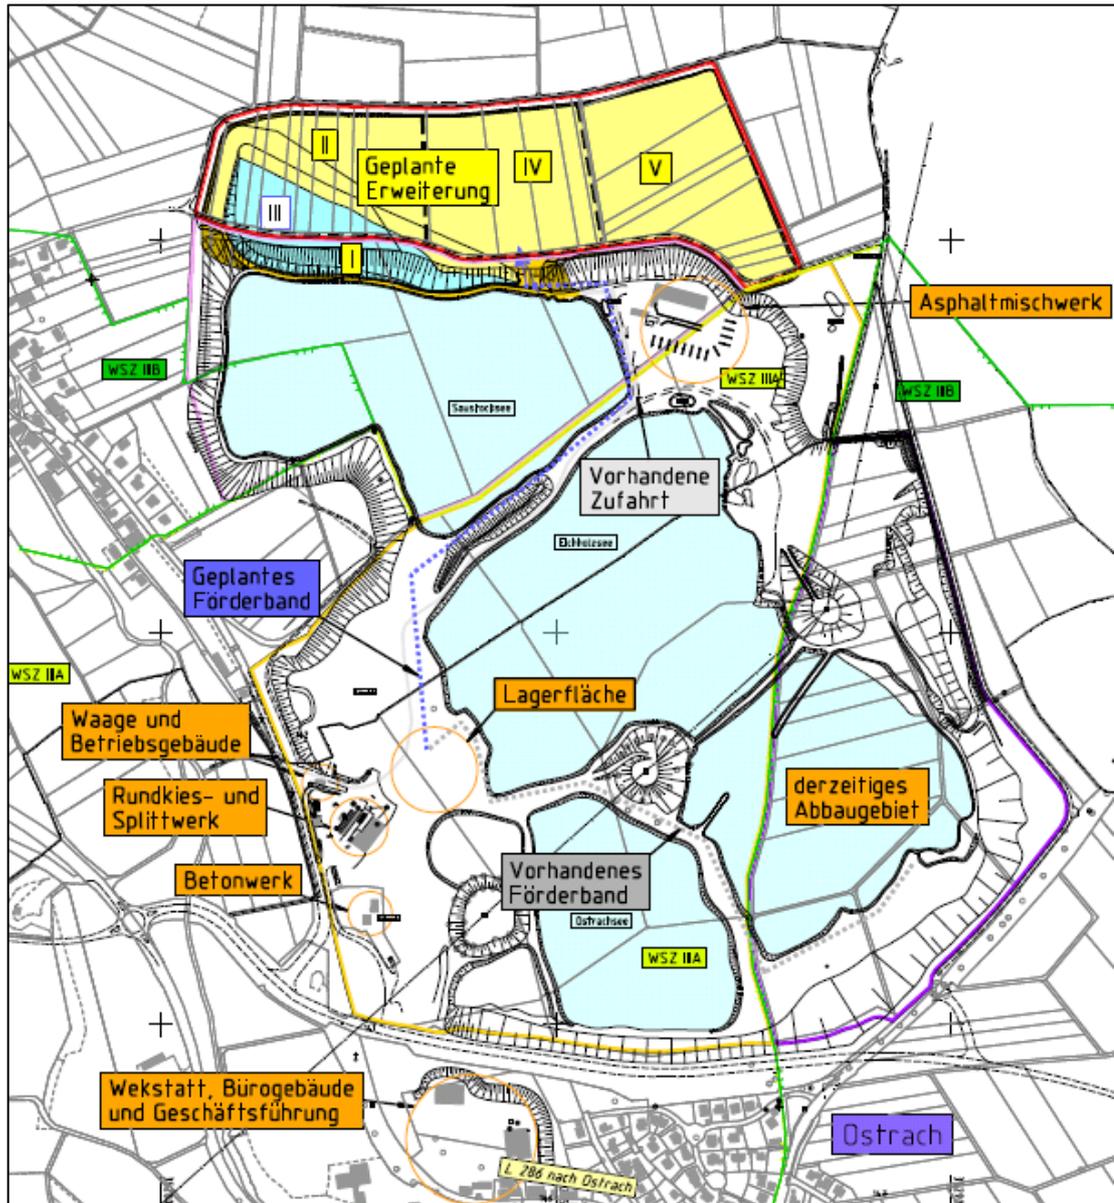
Vorhandenes Betriebsgelände mit bestehenden Werkseinrichtungen, (siehe auch Plan 1.2, M 1:5.000)
